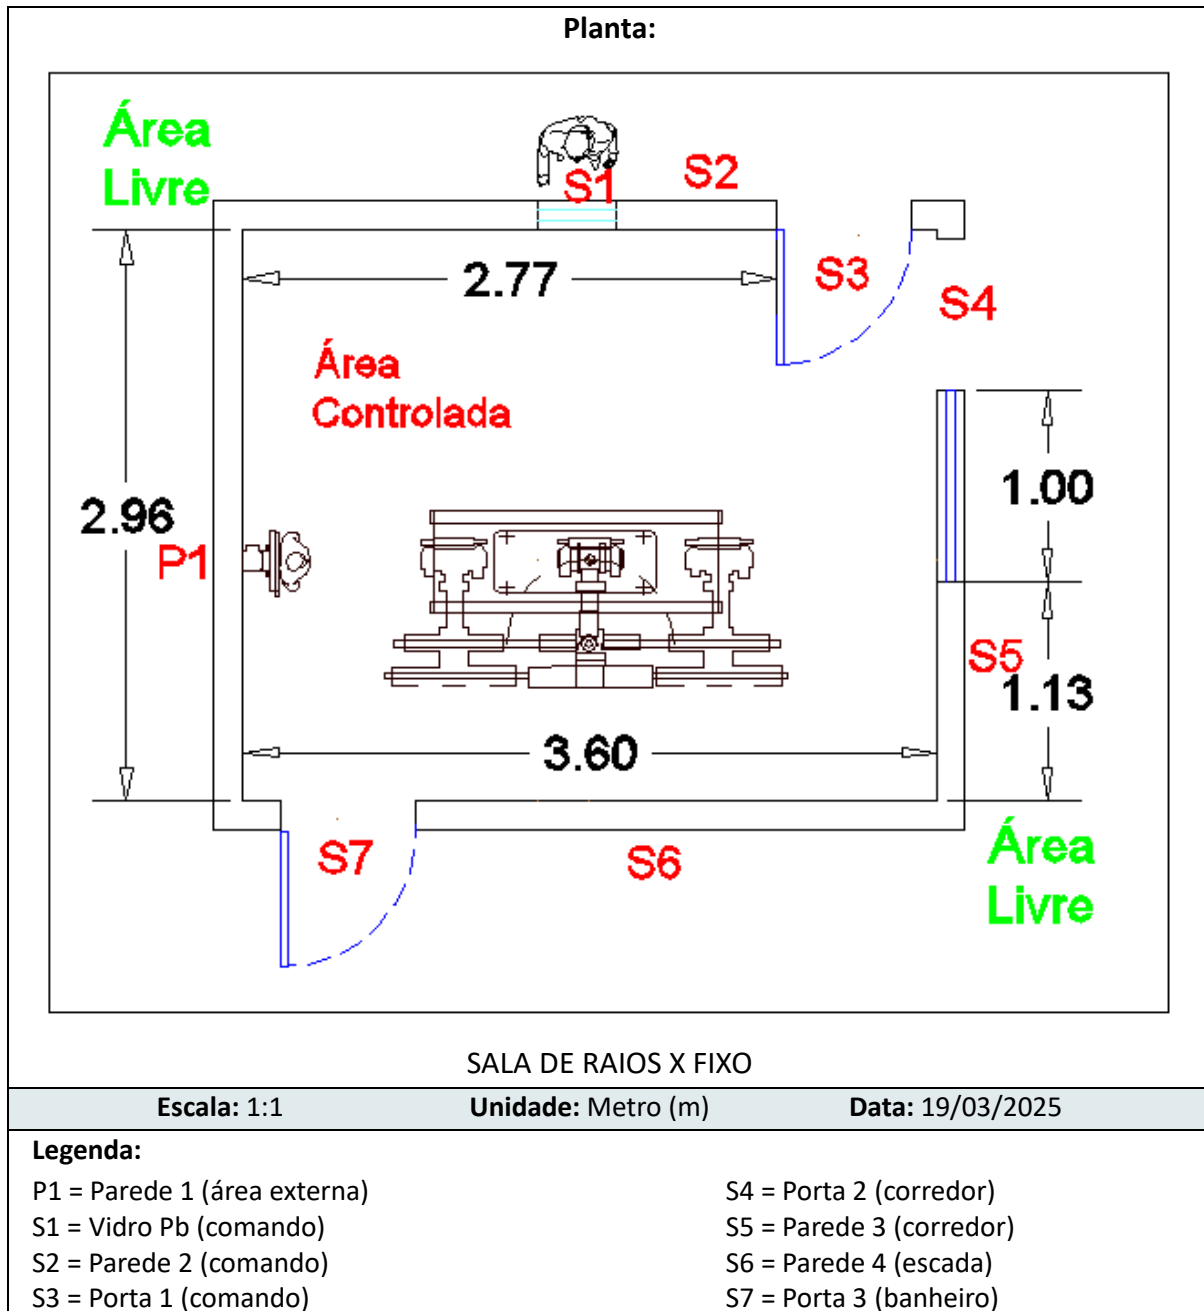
Pontos de medição da sala onde se encontra instalado o equipamento.
